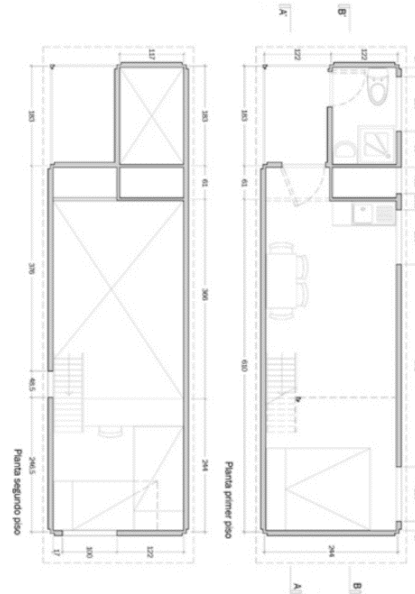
Plantas de vivienda. Fuente: Gubins, J y Baixa, J. (2013).
